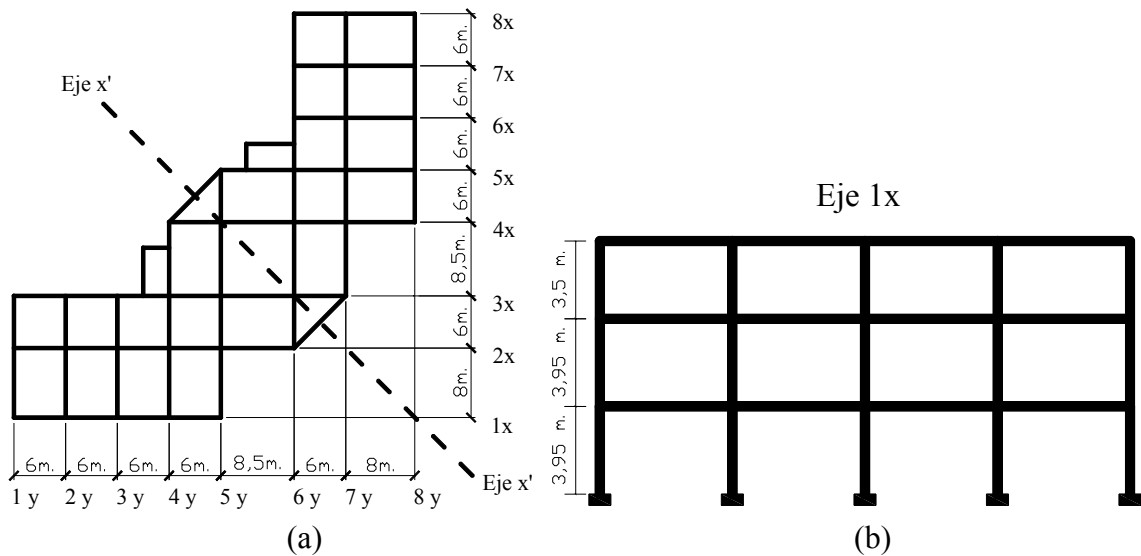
4 (a) Planta de Biblioteca de las Ingenierías y Arquitectura. (b) Marco estructural típico.
